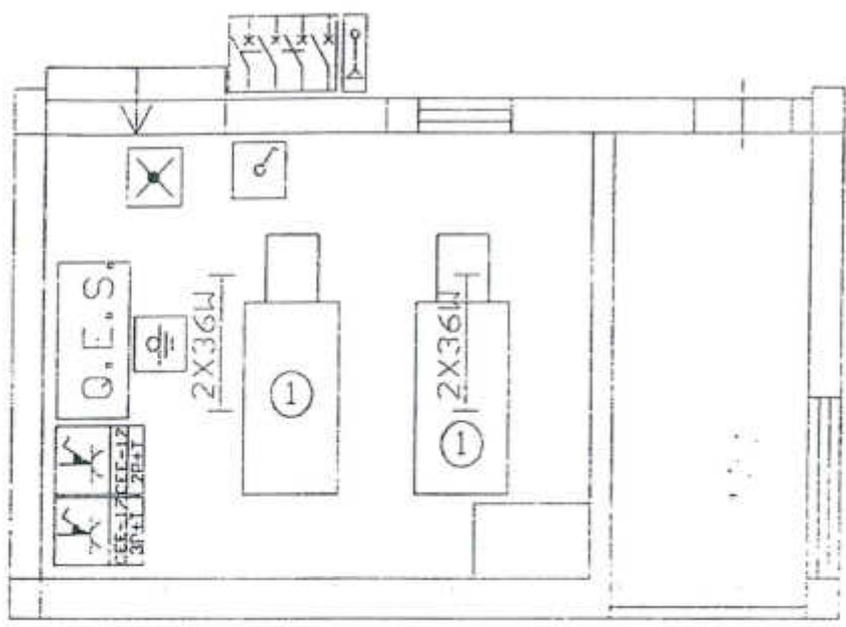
Pianta del locale caldaia e schema impianto elettrico dedicato.
